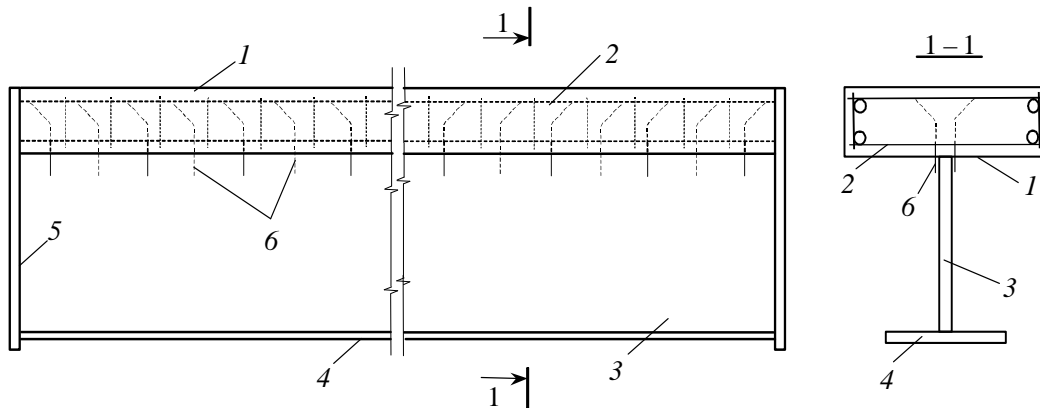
Сталезалізобетонна двотаврова балка із залізобетонним верхнім поясом: 1 – залізобетонна полицка; 2 – арматурний каркас; 3 – сталеві стінка; 4 – сталеві полицка; 5 – опорне ребро; 6 – анкери
